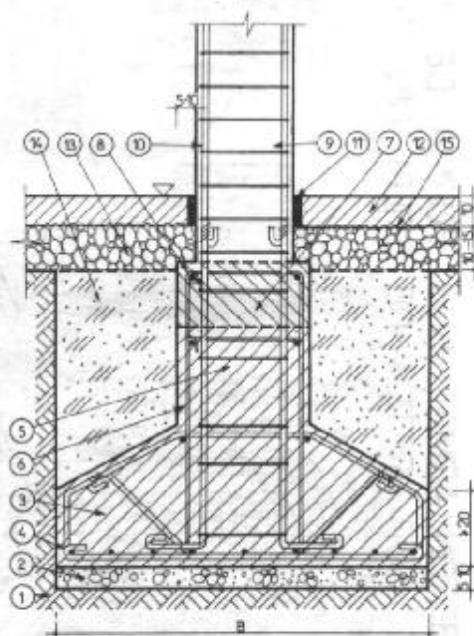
Fundație elastică de beton armat, cu tălpi continue încruzișate, sub formă de grinzi cu vute, sub rețea de stîlpi de beton armat.
